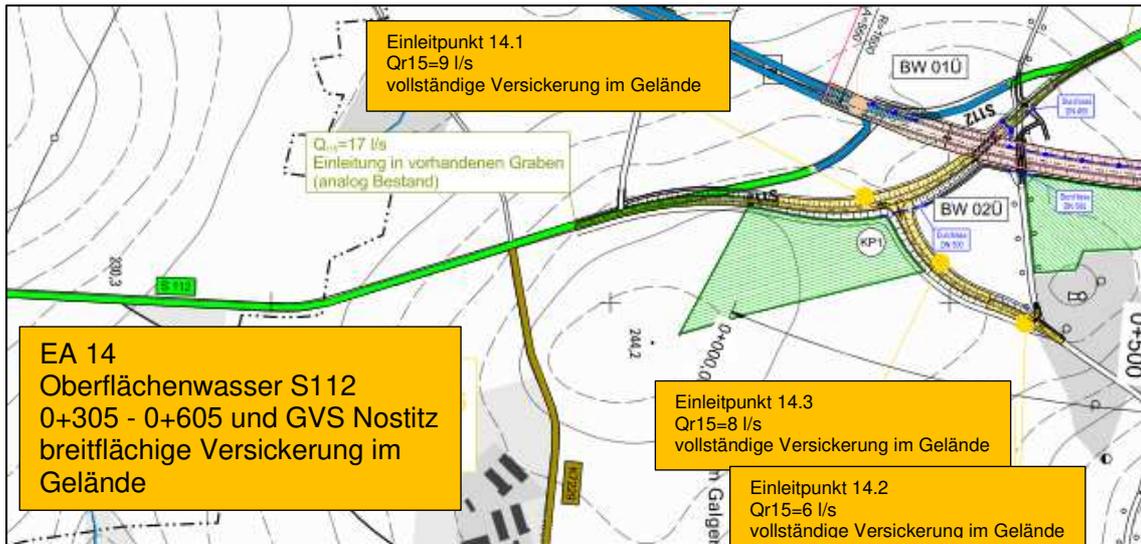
Entwässerungsabschnitt EA 14 (Ausschnitt aus Übersichtslegeplan Entwässerung, Unterlage 8)
